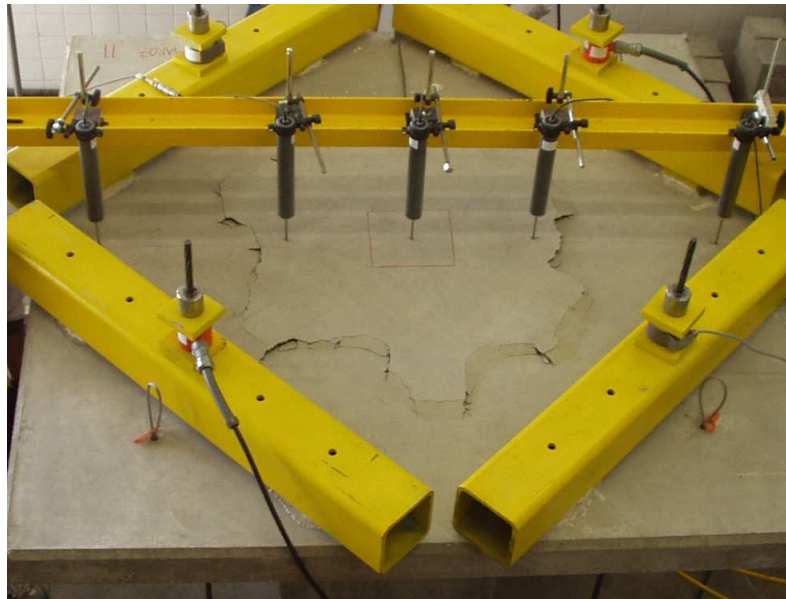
Vista do modelo R após a rotura por punçoamento
